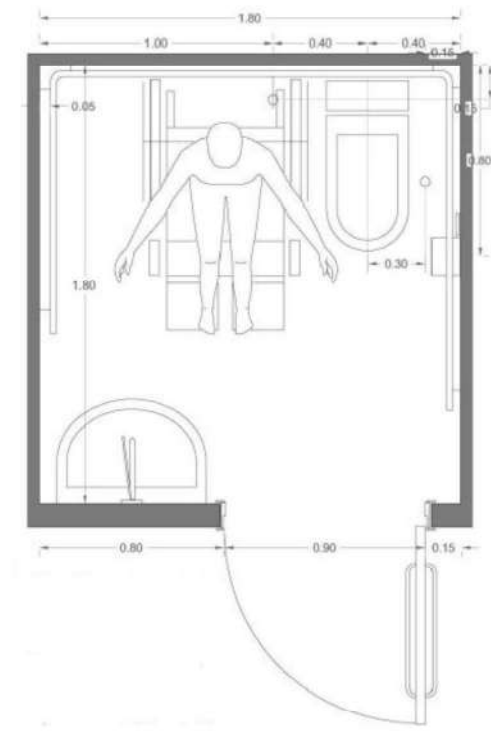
Pianta servizio igienico con lavabo e dimensioni minime 1,80x1,80m
